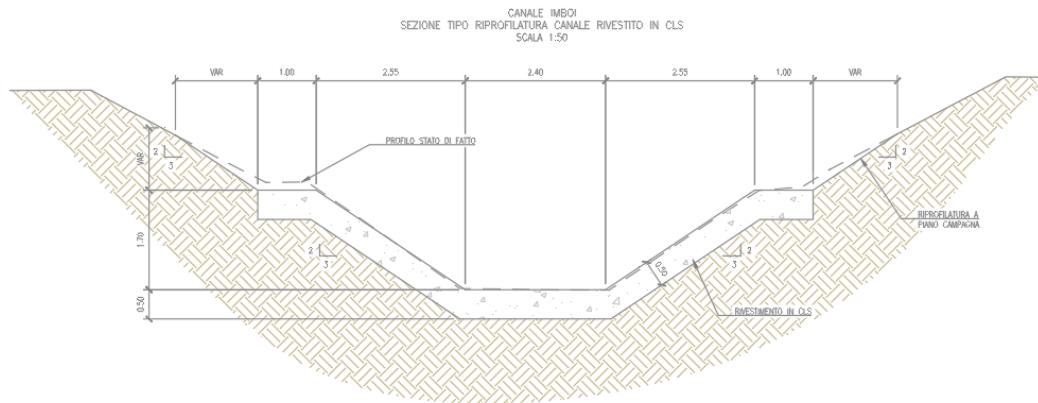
Sezione tipo canale Imboi (tratto rivestito)
